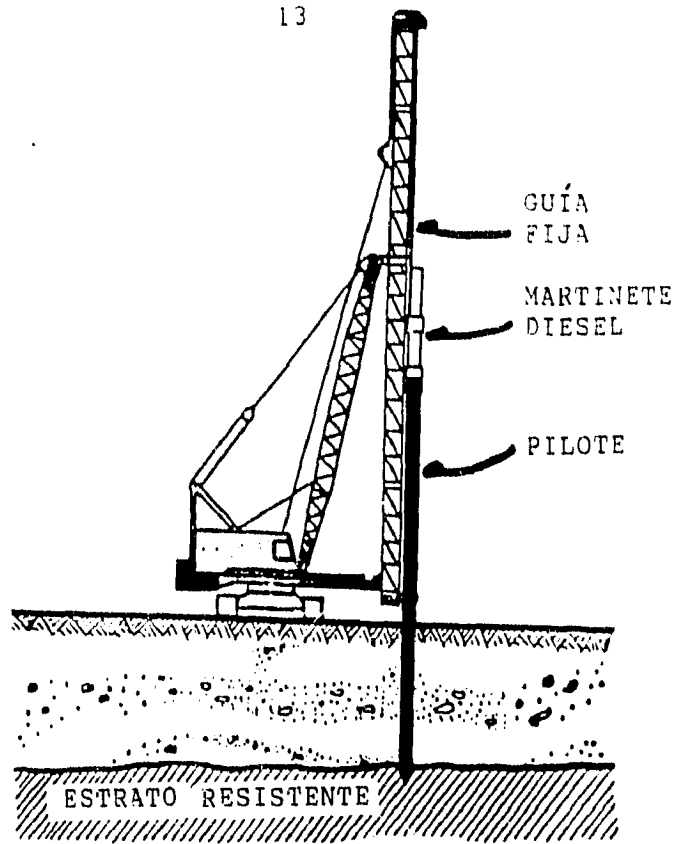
PILOTE HINCADO VERTICALMENTE.
